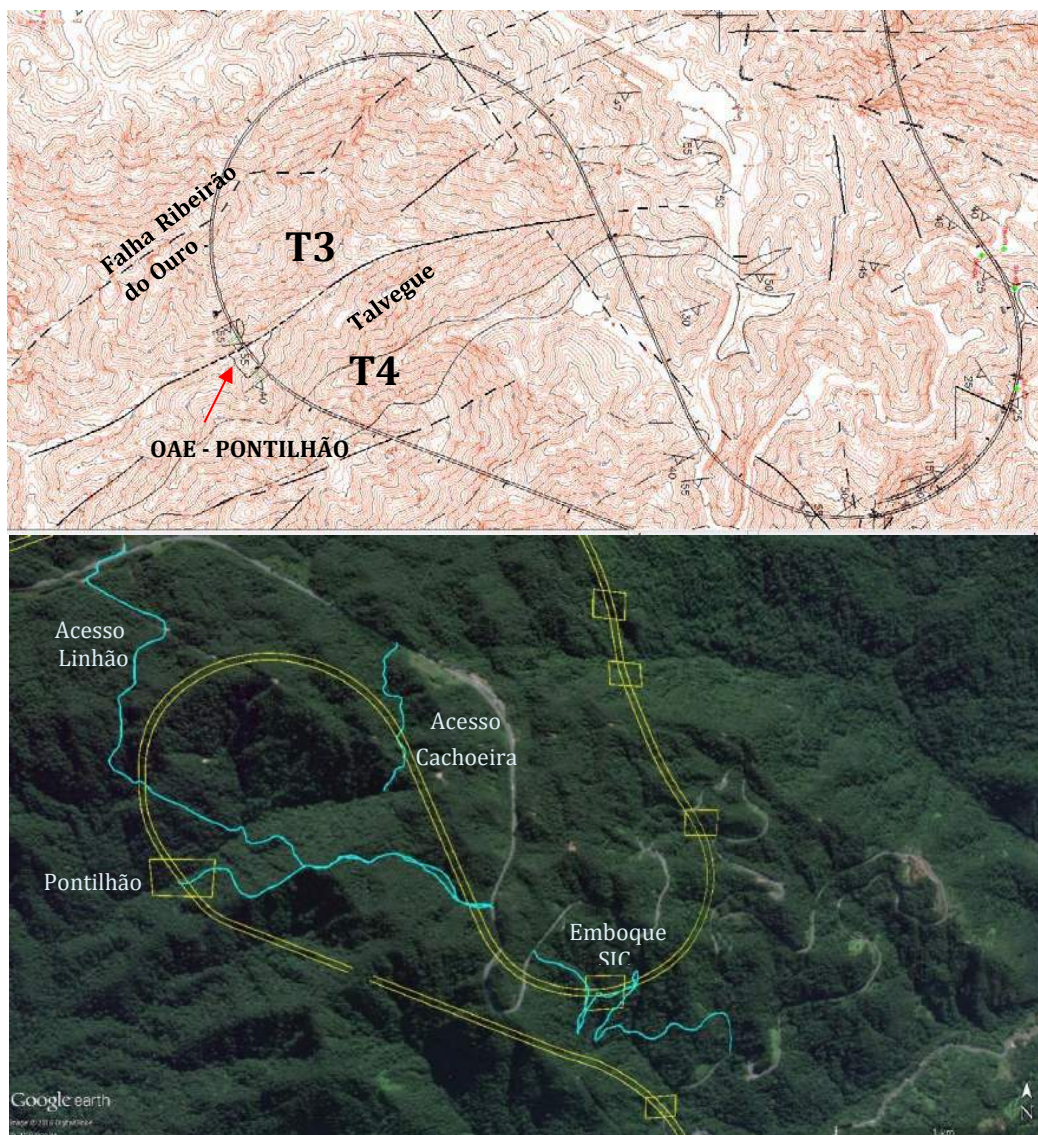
Implantação geométrica e ortofoto do traçado do túnel T3 acima da linha do talvegue e T4 abaixo da linha (Fonte: Construtora Queiroz Galvão)
